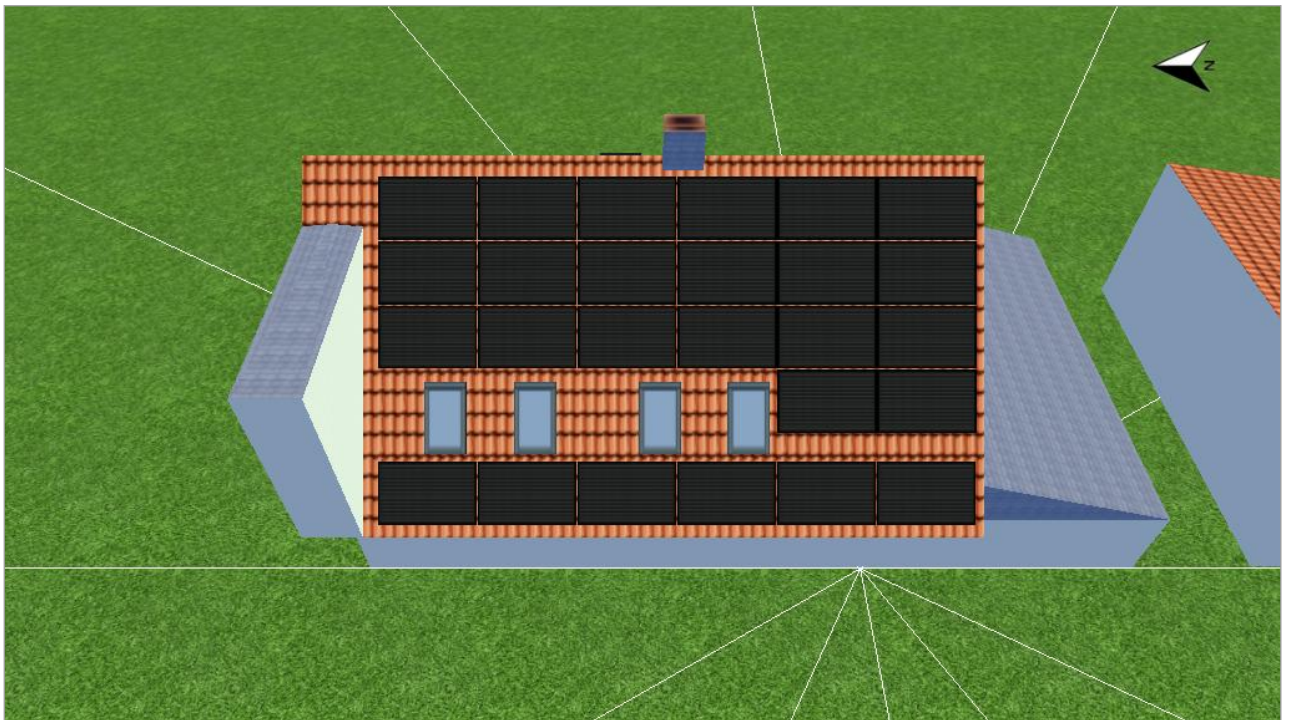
Modulfläche - Gebäude 01-Dachfläche West
